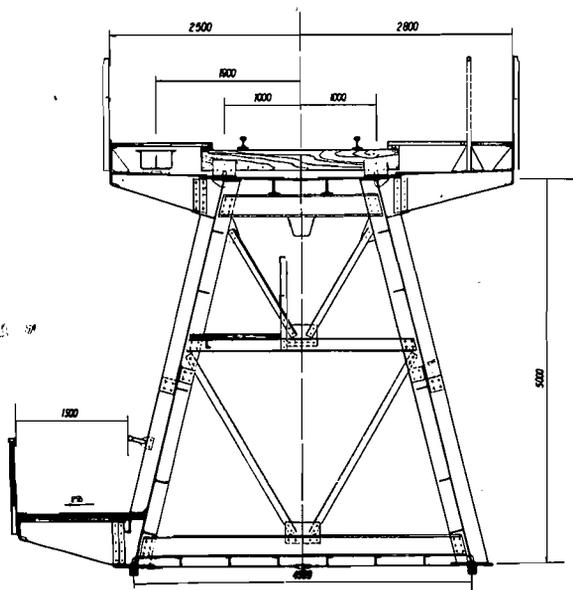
Jauntalbahn-Draubücke, Kastenquerschnitt
